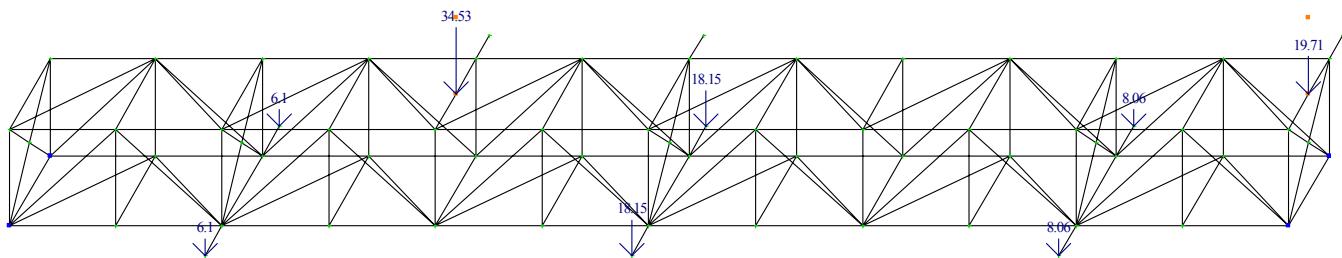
Вертикальные нагрузки от существующих трубопроводов
